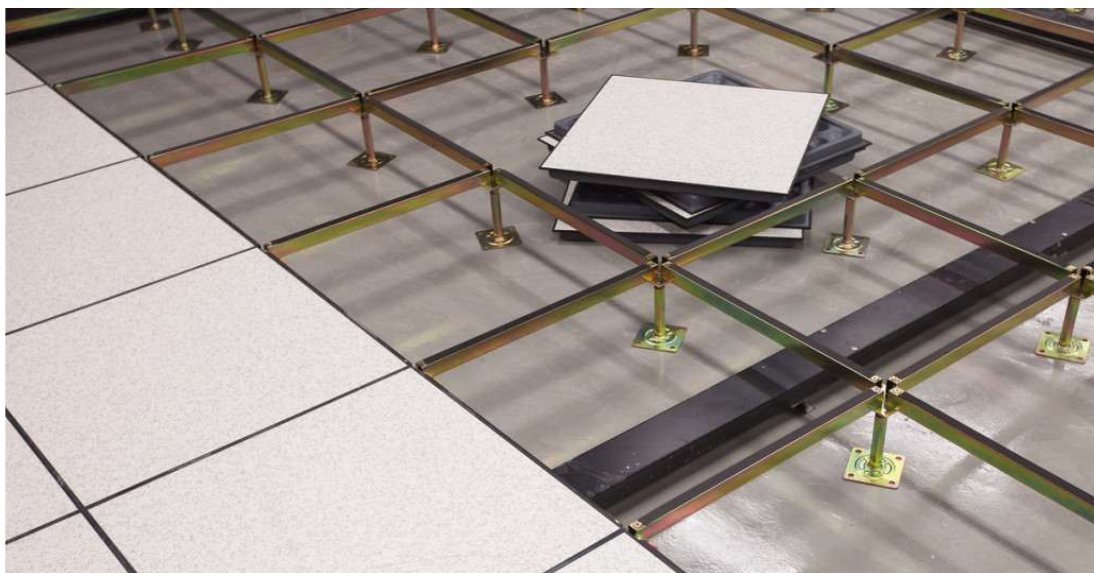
Esempio di pavimento galleggiante. Si noti che le piastrelle in composito multistrato devono essere appoggiate perfettamente sulla struttura portante in acciaio.
